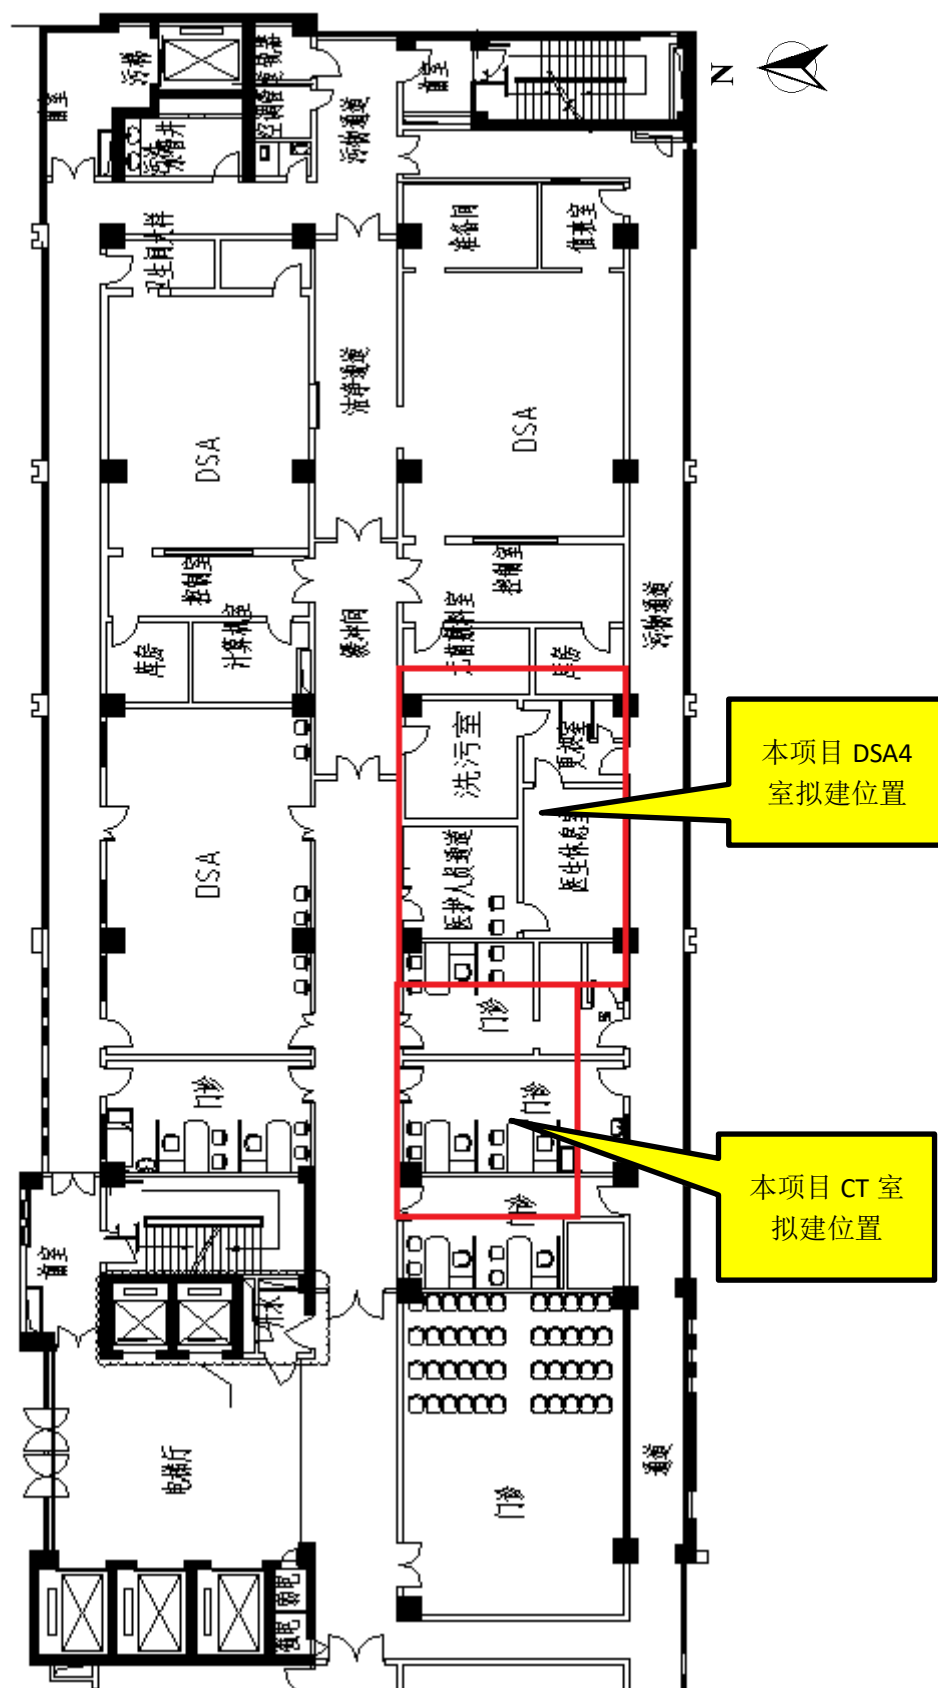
本项目所在楼层改建前平面图（3 号楼 2 层）
